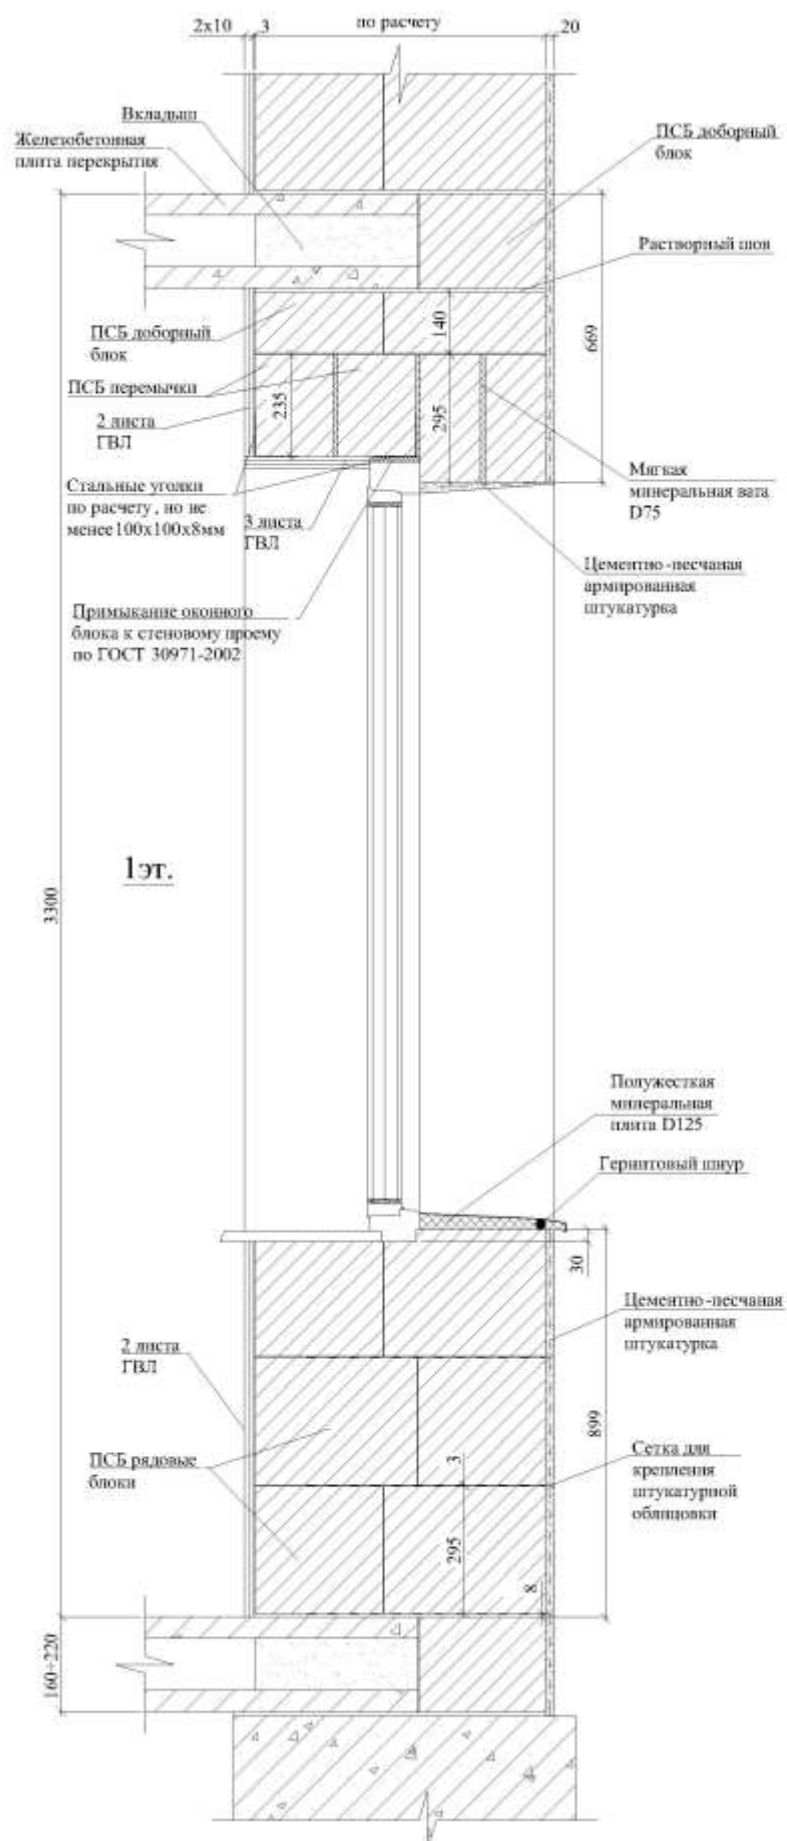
Несущая стена из полистиролбетонных блоков с фасадной штукатуркой. Вертикальный разрез по оконному проему
